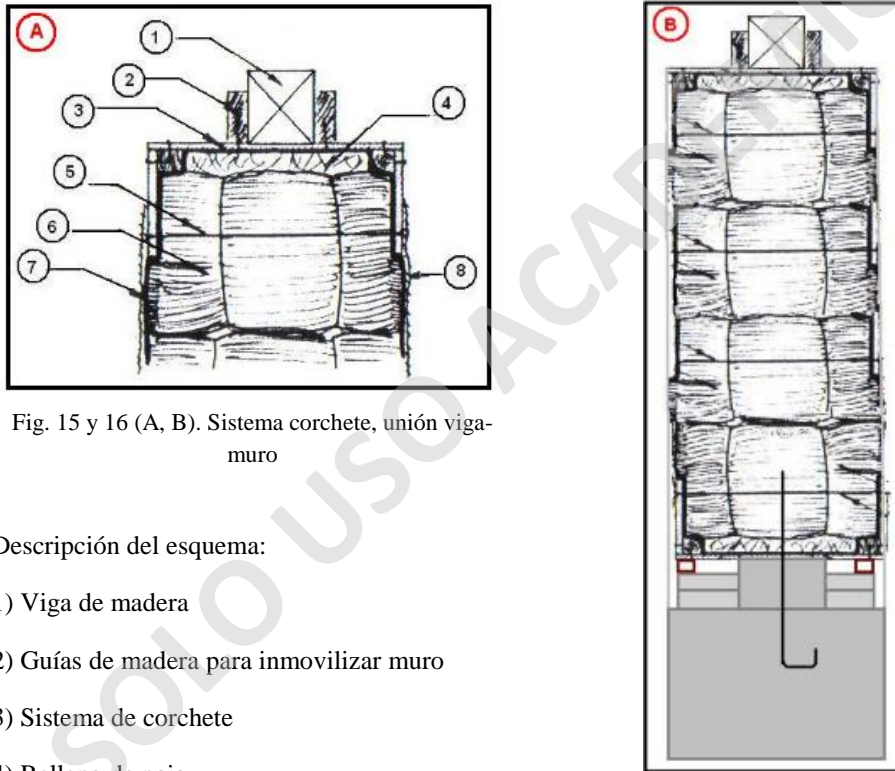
y 16 (A, B). Sistema corchete, unión viga-muro
